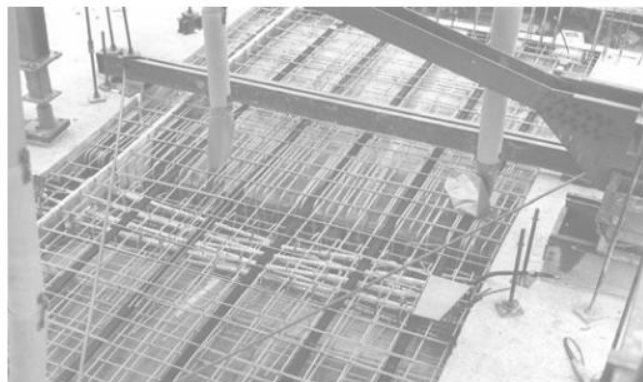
Meja Pier Dari Konstruksi Kantilever Seimbang Cor Di Tempat.
